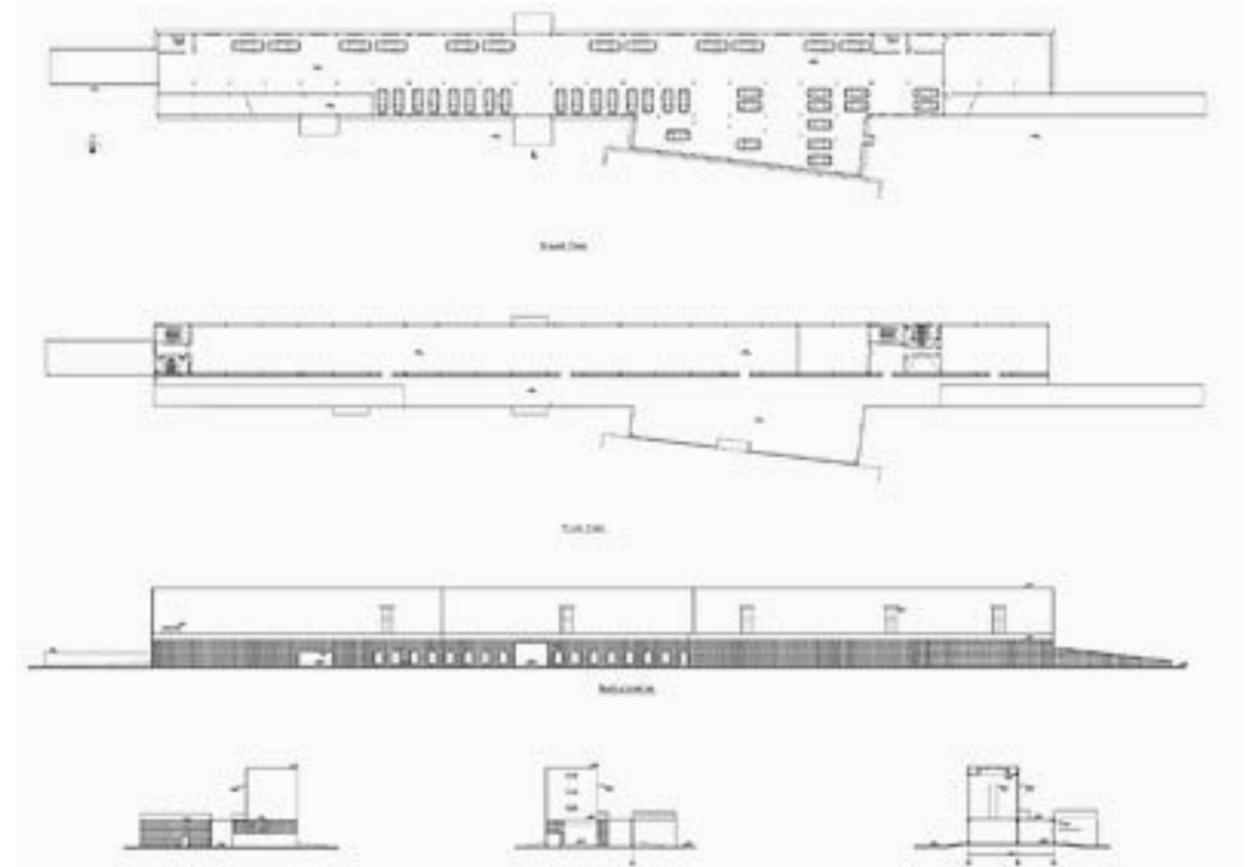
23. Planos del edificio 10: Galería. (Imagen extraída en red: world-architects.com).
